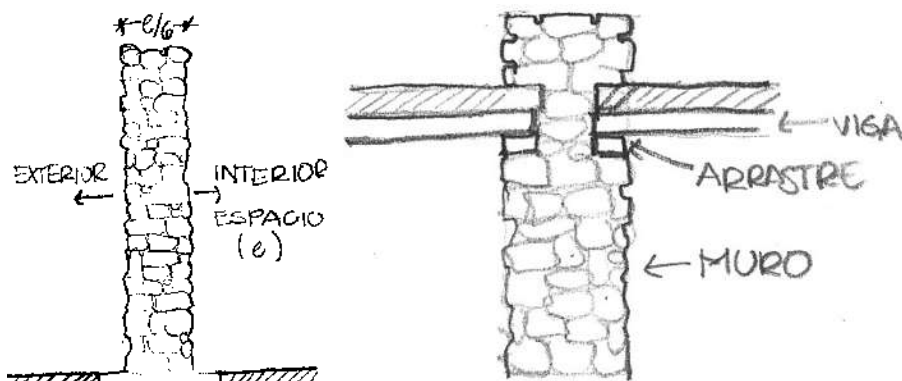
Croquis de sistema constructivo de apoyos corridos. Elaboró: METR
